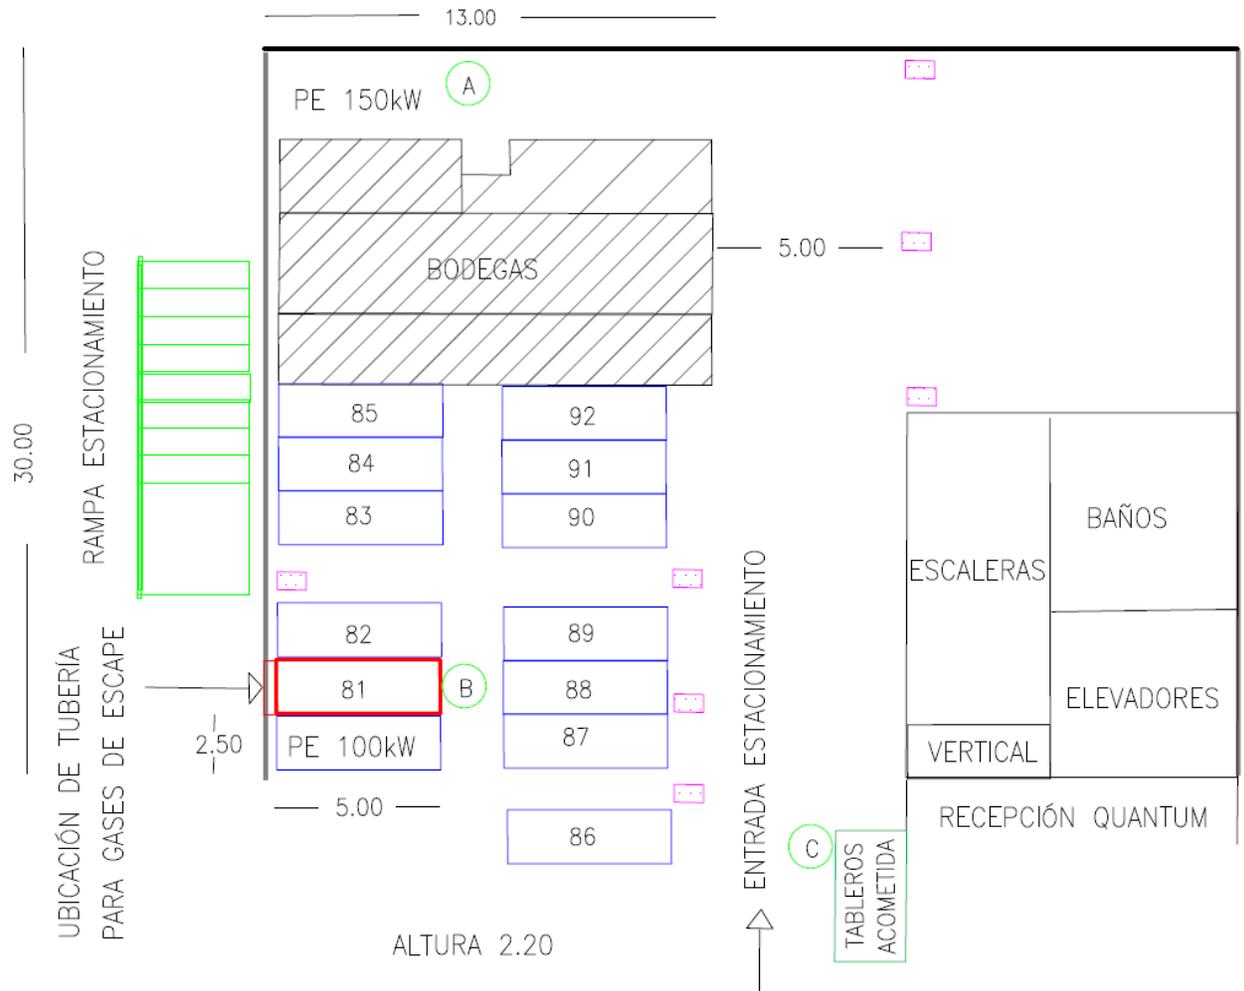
Ubicación de la planta de emergencia en Planta Baja (estacionamiento) del Edificio de Quantum.
